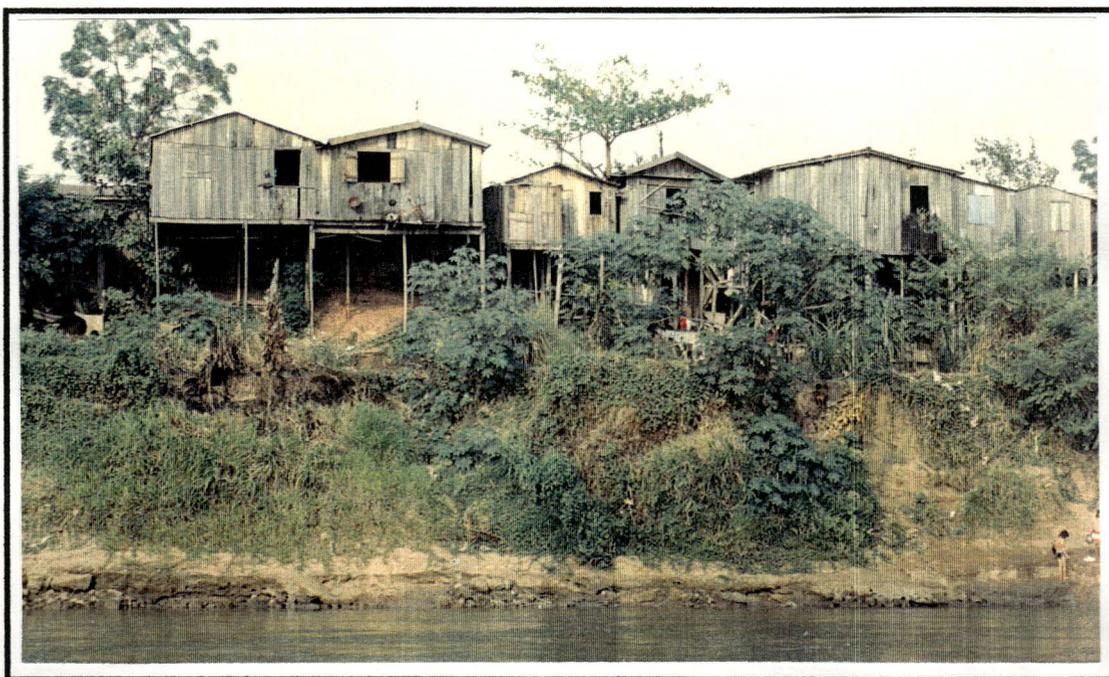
Habitação construída em palafita com cobertura de telha de fibrocimento.
